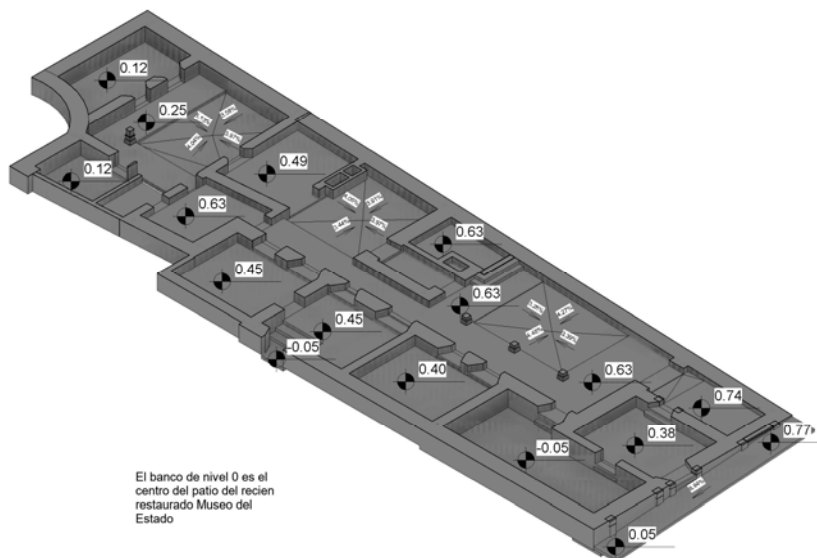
Plano CAMEM A100-1 Registro de Niveles. Elaboró: METR
